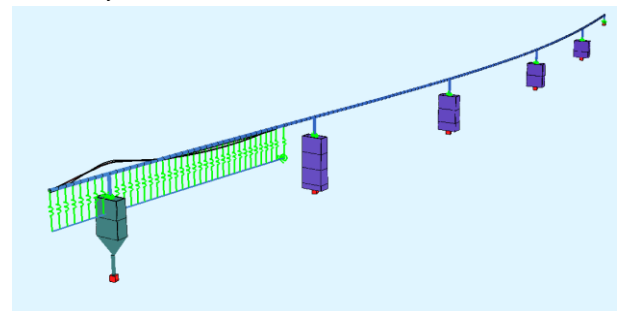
Detalle del modelo de cálculo de interacción tablero–autocimbra.
